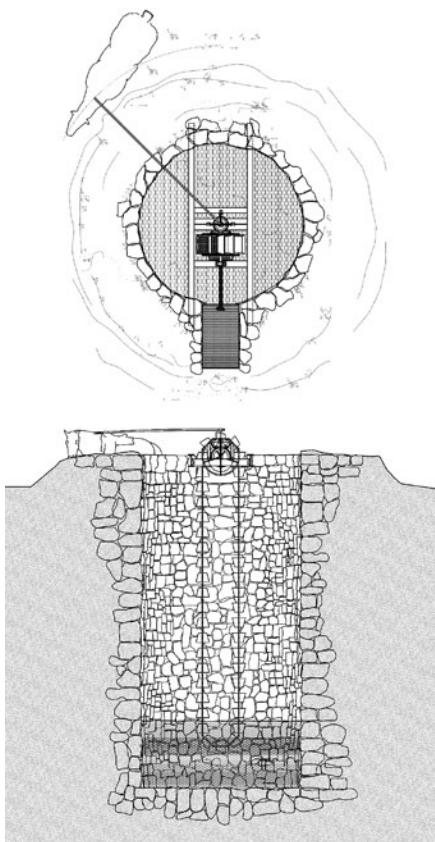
Planta y sección de la perforación y de la noria. Fuente: autor
